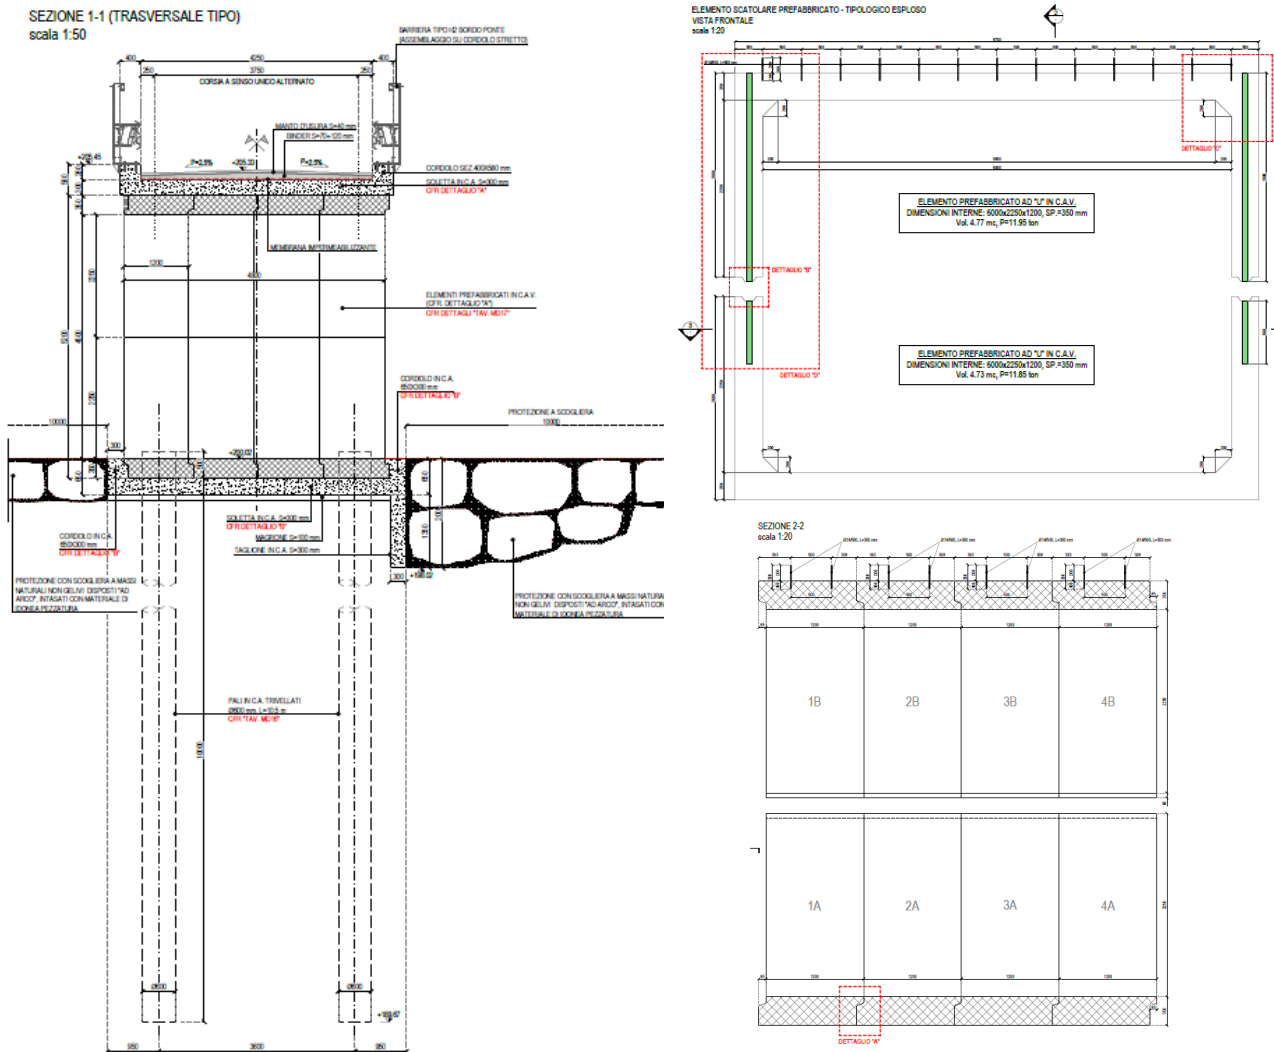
Ponte-Guado, Sezione trasversale e geometria elementi prefabbricati
